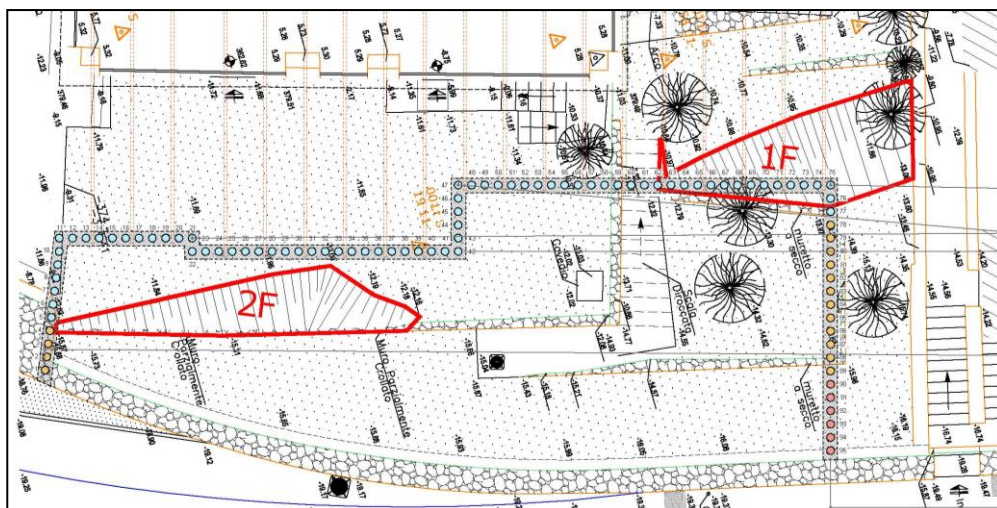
Planimetria con individuazione delle zone in frana e palificata
